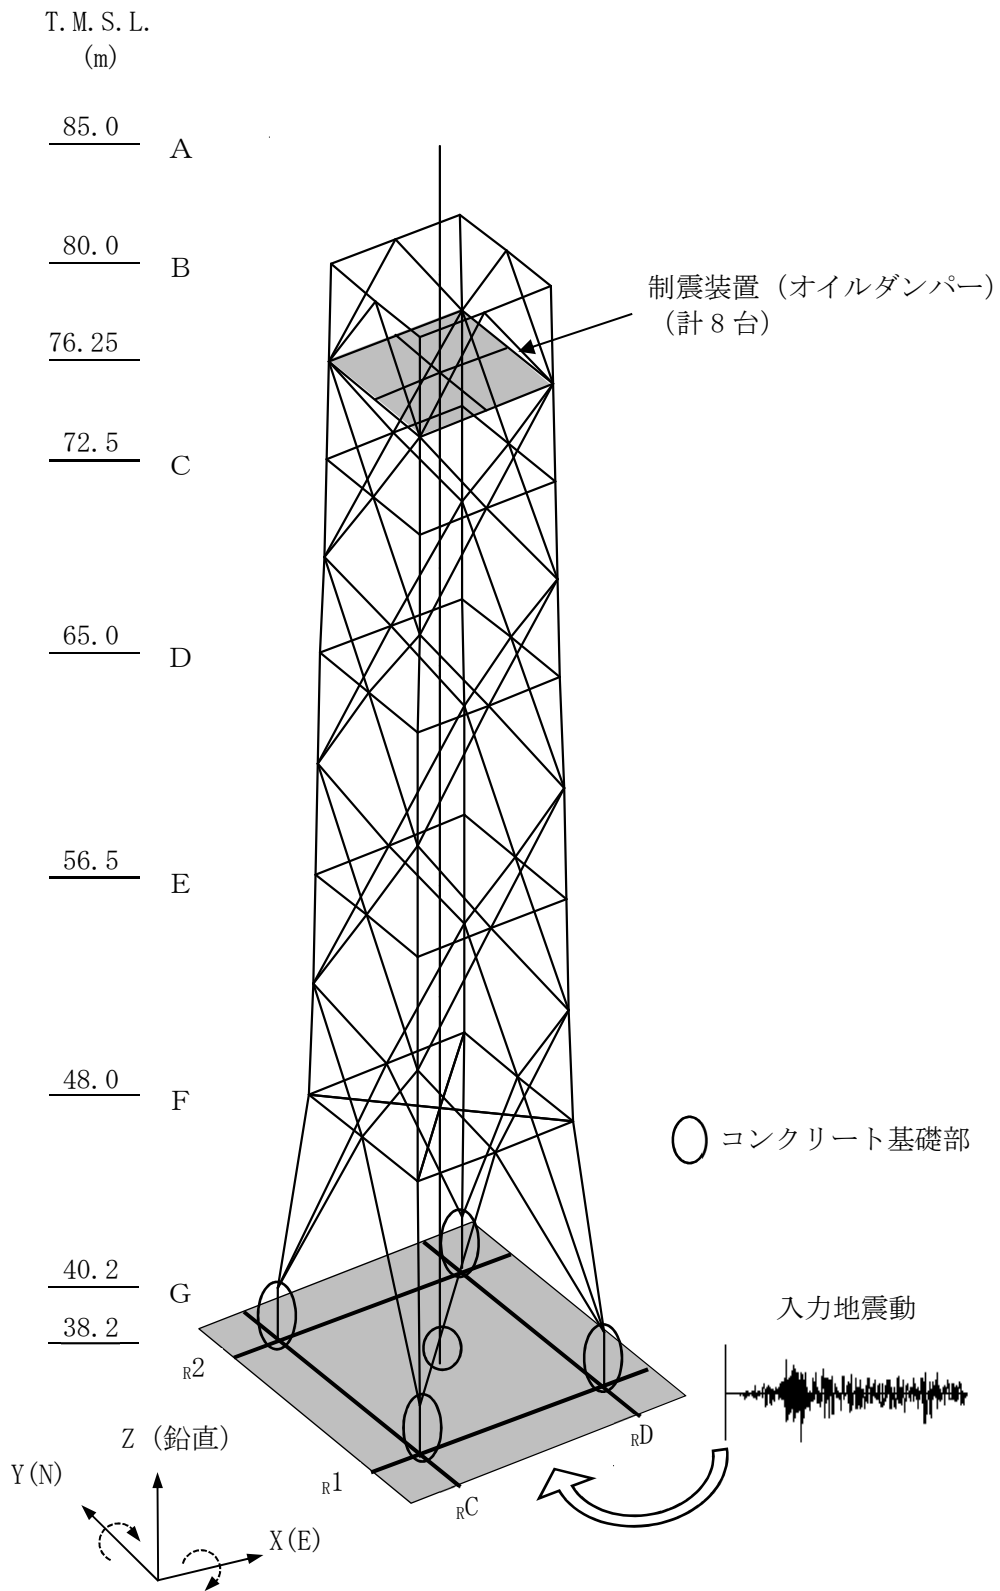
主排気筒の基礎の概要図 (単位 : m)
